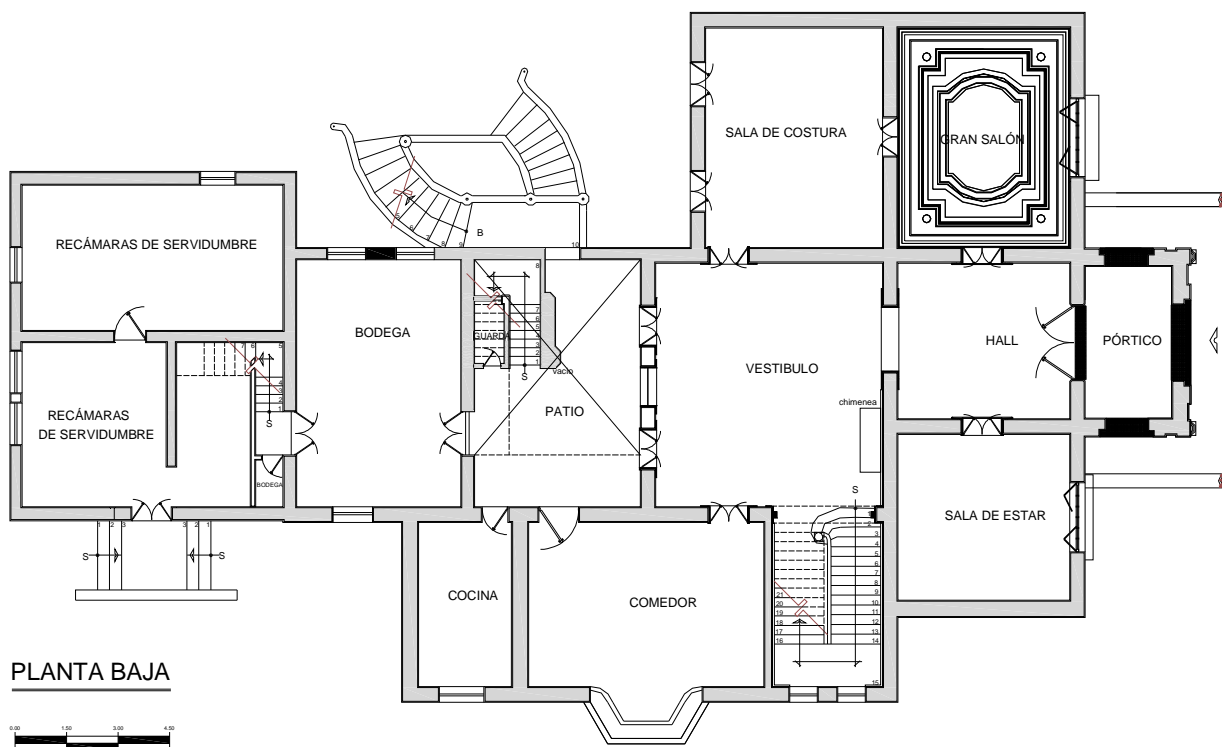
Planta arquitectónica, planta baja de una vivienda veraniega.¹¹⁹
